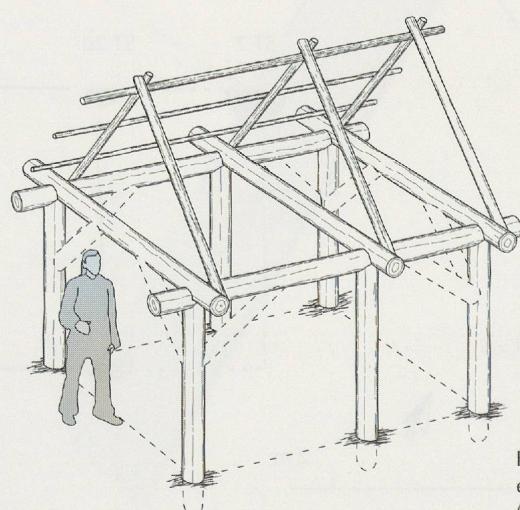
Cuarny-*En Essiex*, le bâtiment 7: essai de restitution architecturale (hypothèse du bâtiment à six poteaux).
